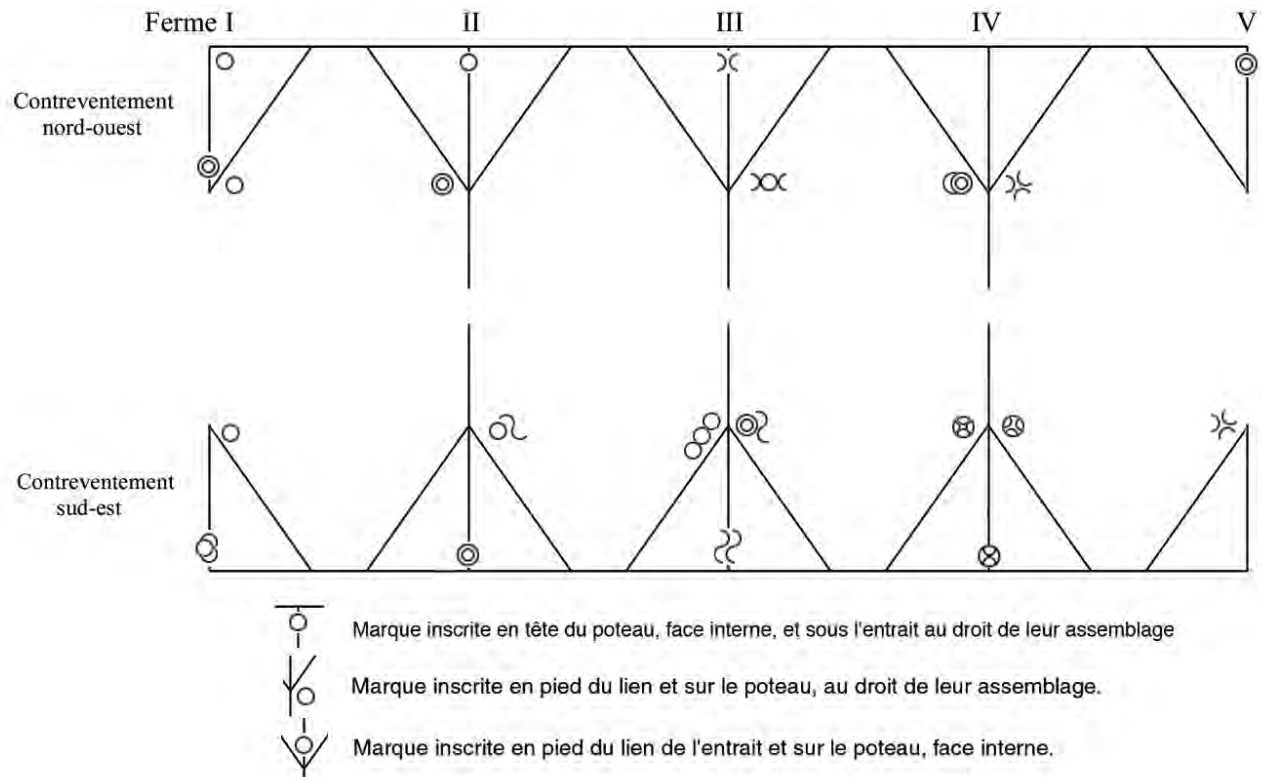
Plan de localisation des marques d'assemblage des poteaux et de leurs liens obliques longitudinaux.
